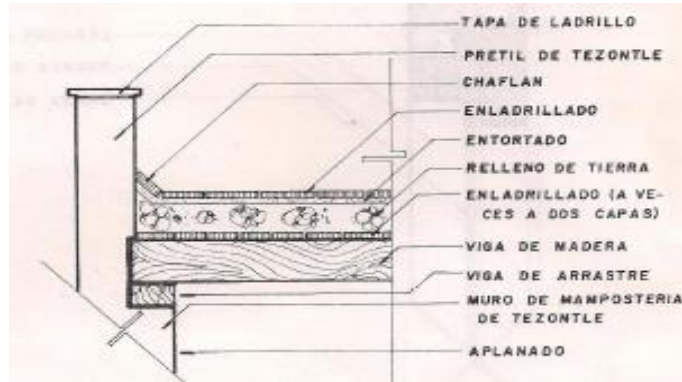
Detalle de Cubierta con la aplicación de cuadrado.
